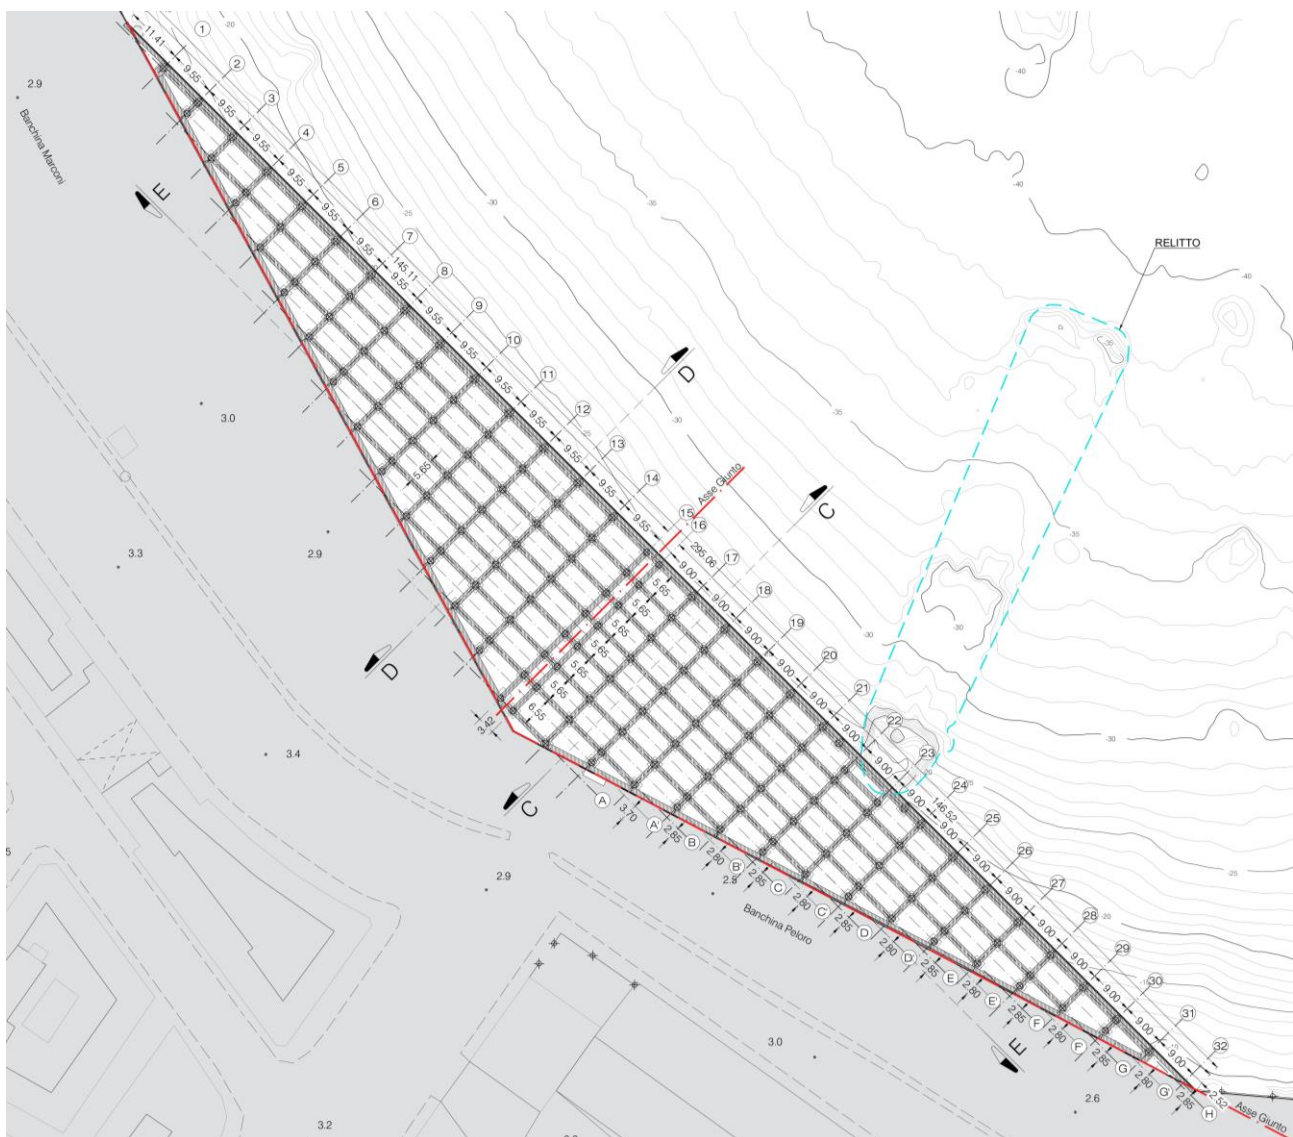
Pianta di Progetto a quota +1.00 m con grigliato delle travi PREM prefabbricate
